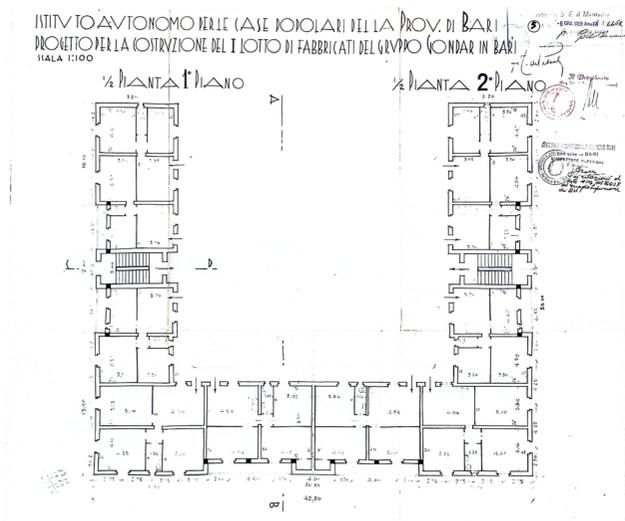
Pianta primo lotto gruppo "Gondar", progetto primo e secondo piano, 1938 (ASB, IACP, b. 11).
